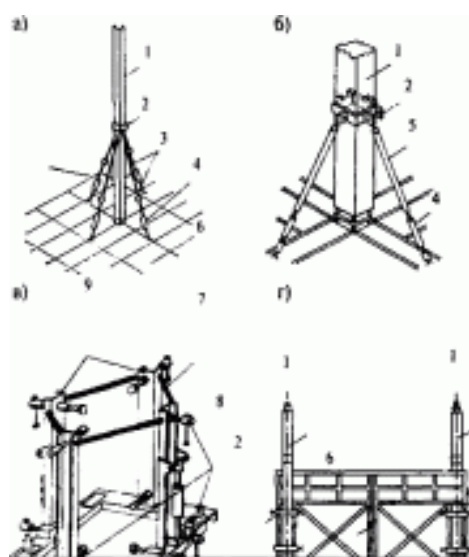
Способы временного крепления железобетонных колонн многоэтажных зданий:
